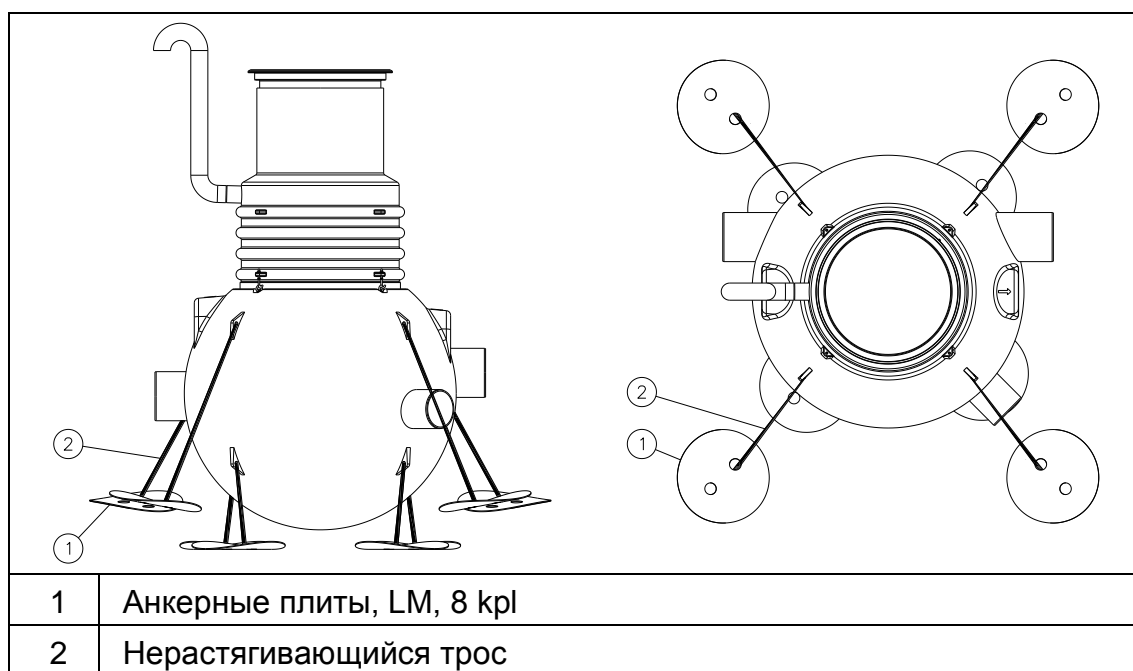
Установка регулирующего колодца NS40/120 - NS100/300 на плиты из армированного стеклопластика.
